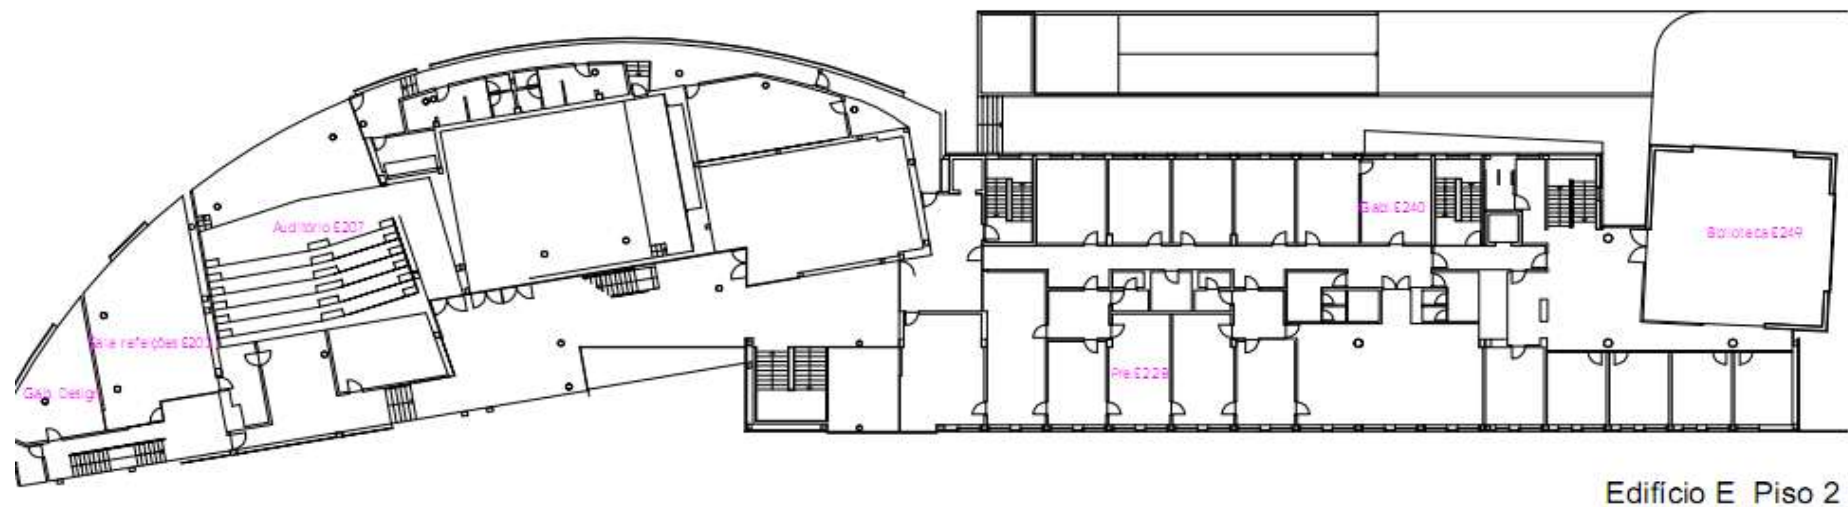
Planta do Edifício E - 2º piso, nas instalações onde foram efectuadas as medições de QAI
